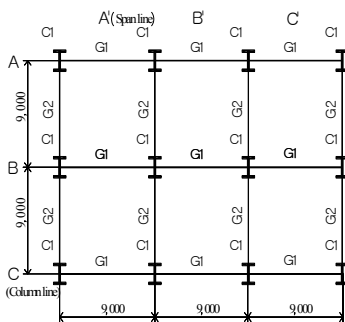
대상 건물의 기준층 평면도 (Unit: mm)
